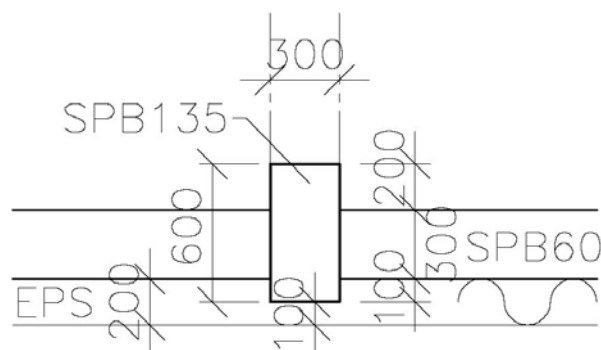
Posuzovaný detail objektu ze strany interiéru a exteriéru před zateplením
